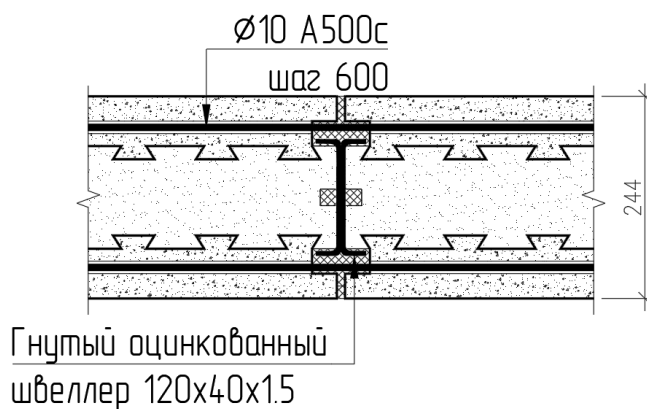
Узел Б. крепление центральных вертикальных гнутых швеллеров (П-профилей) к несущей плите перекрытия, покрытия, ригеля
